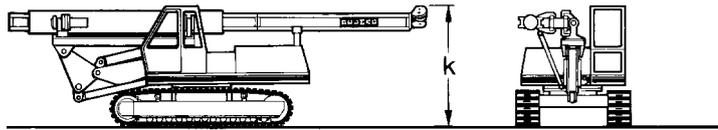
Transportstellung Mäkler auf Trägergerät [13]
